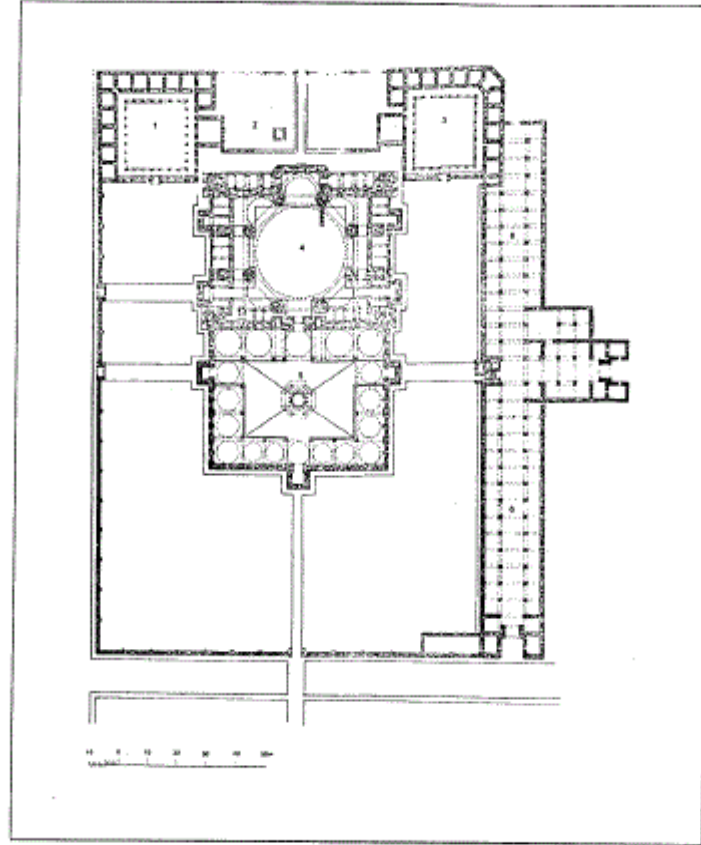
مسقط أفقي لمجمع (كلية) بايزيد الثاني في أدرنة (عن : جودوين) .
